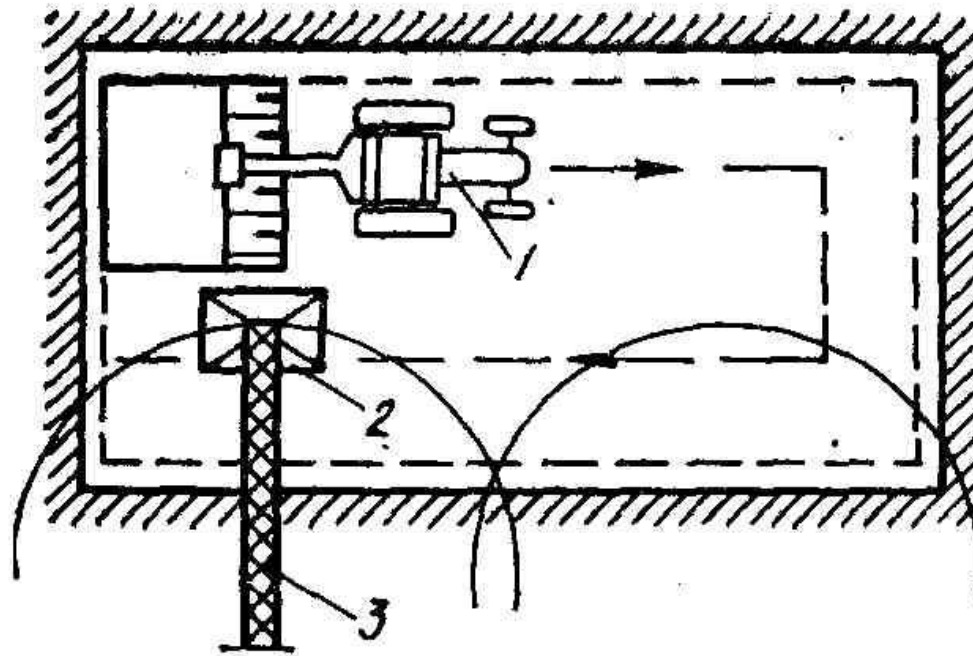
Разработка грунта с использованием экскаватора и крана в особо стесненных условиях:
